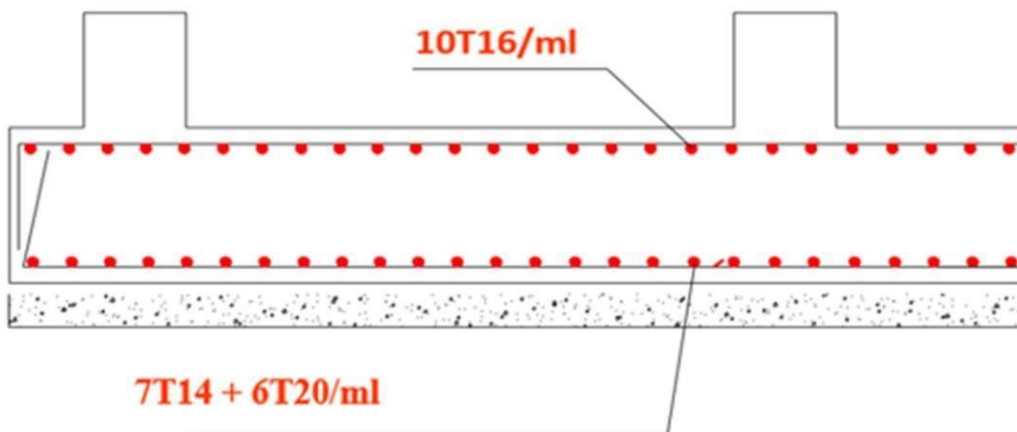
schéma de ferrailage de la dalle du radier sens y-y
